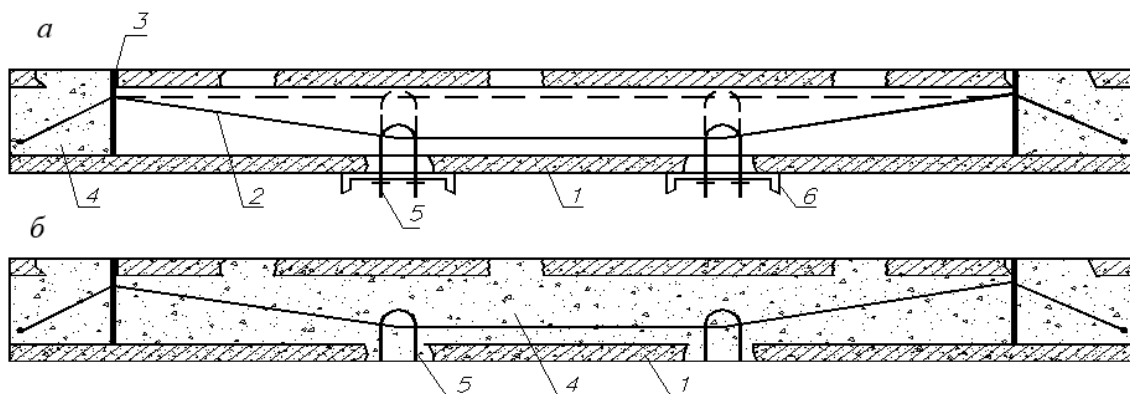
Усиление сборных многопустотных плит предварительно напряженной арматурой:
